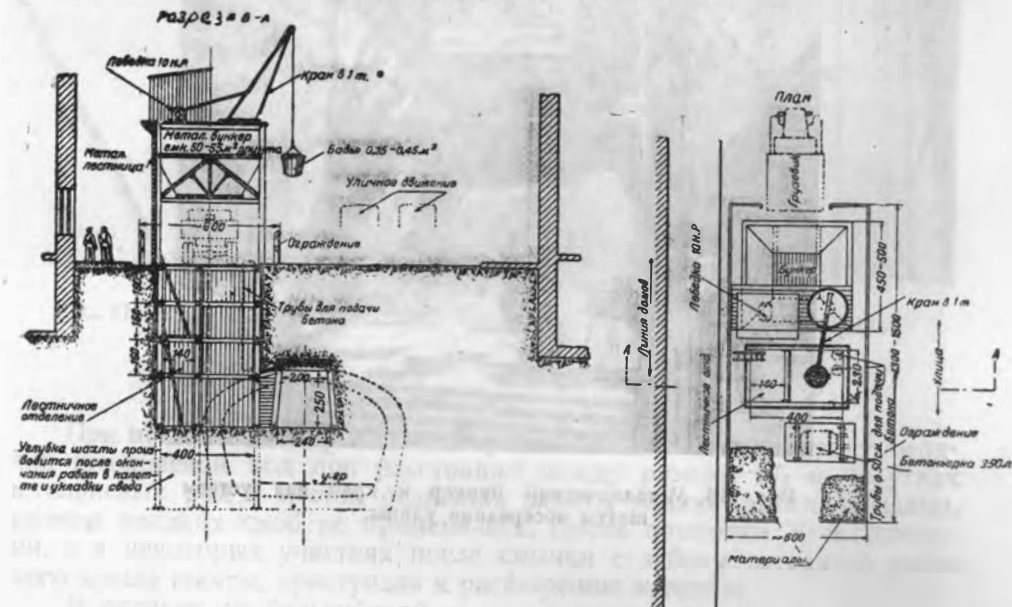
Организация шахтной площадки при сооружении тоннеля парижским способом.
